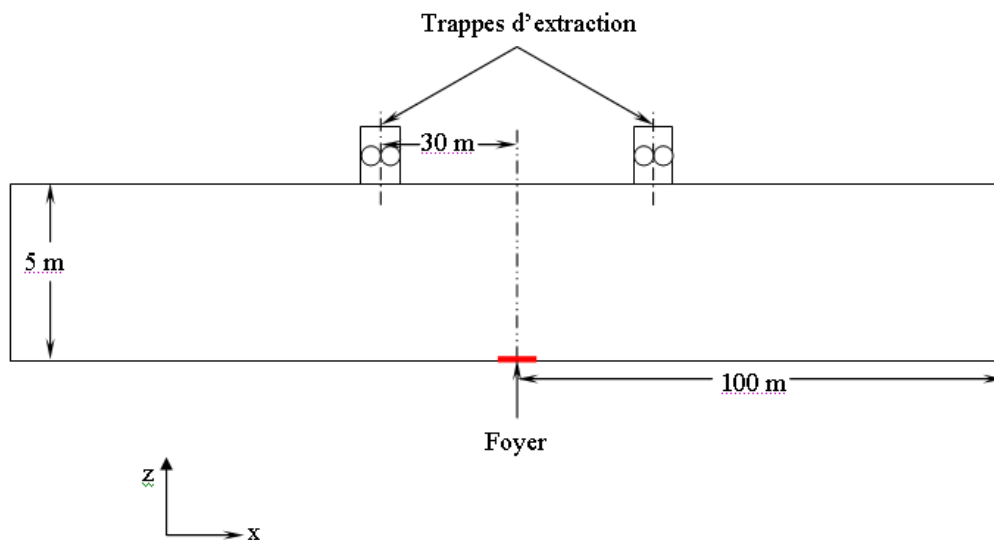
Schéma d'un tunnel routier muni d'une ventilation transversale.
